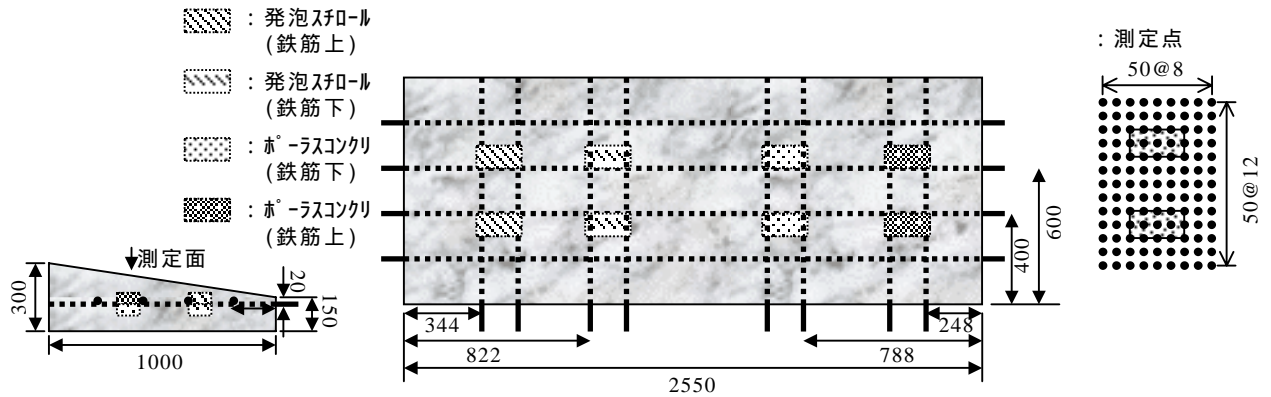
供試体（左図：左側面図、中図：平面図）および測定点状況（右図）（単位 mm）
